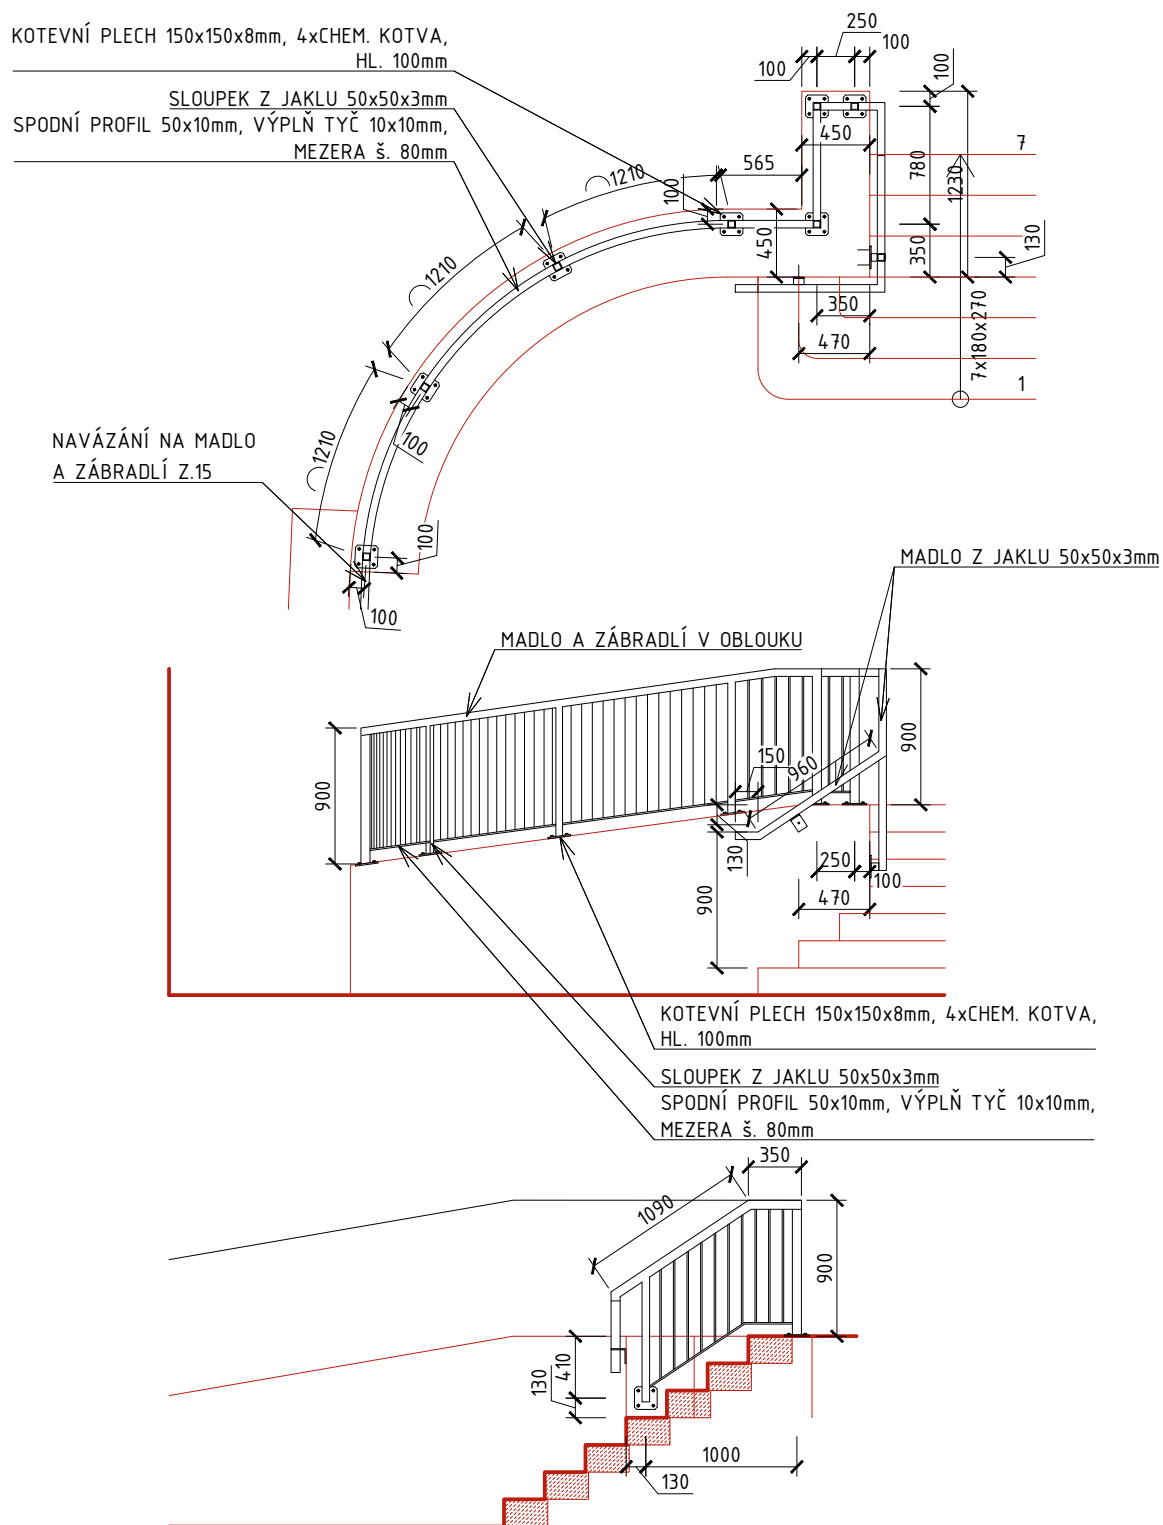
DETAIL KOTVENÍ SLOUPKŮ A KONSTRUKCE VIZ DETAIL U PRVKU Z.15
